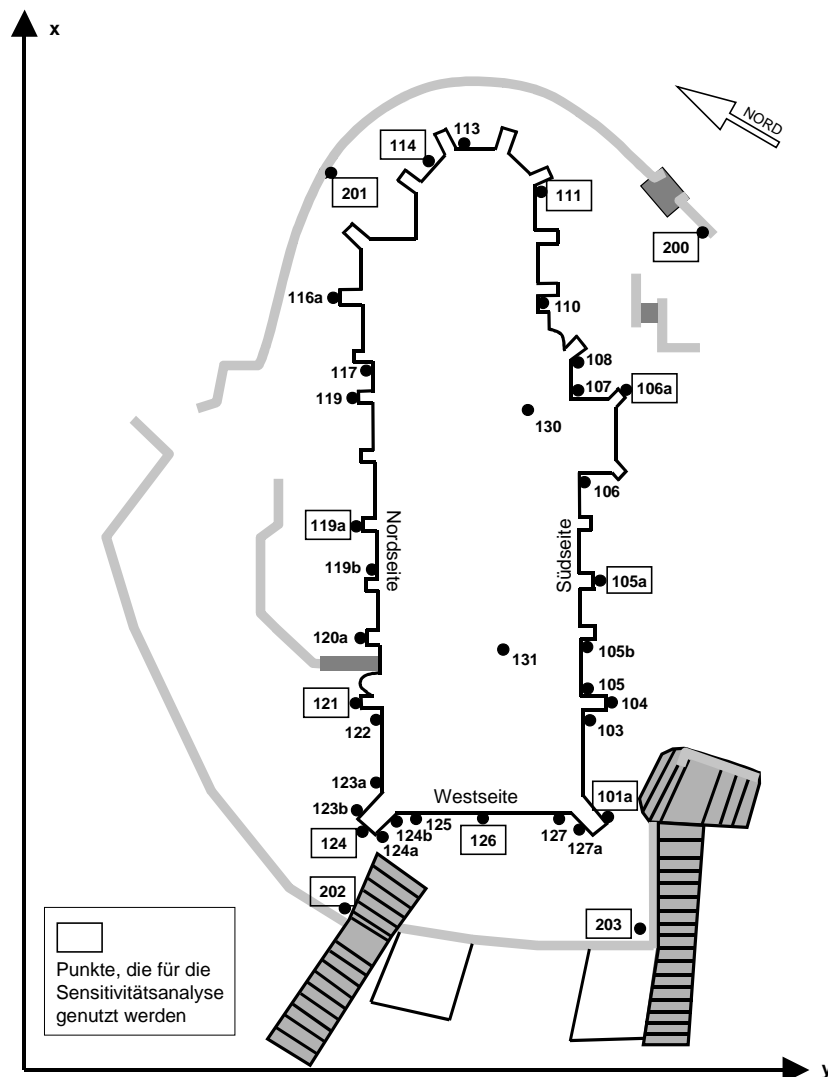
Grundriss der Stiftskirche Herrenberg und Höhenmesspunkte
